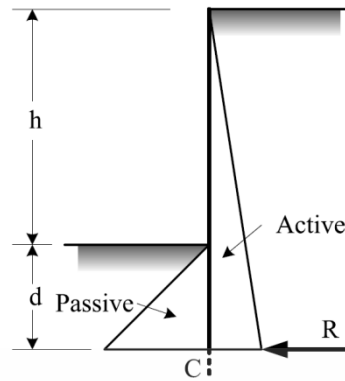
ความดันดินด้านข้างที่กระทำต่อ Cantilever sheet pile wall (รศ.ดร. สุขสันต์ หอพิบูลสุข, 2553)[3]
